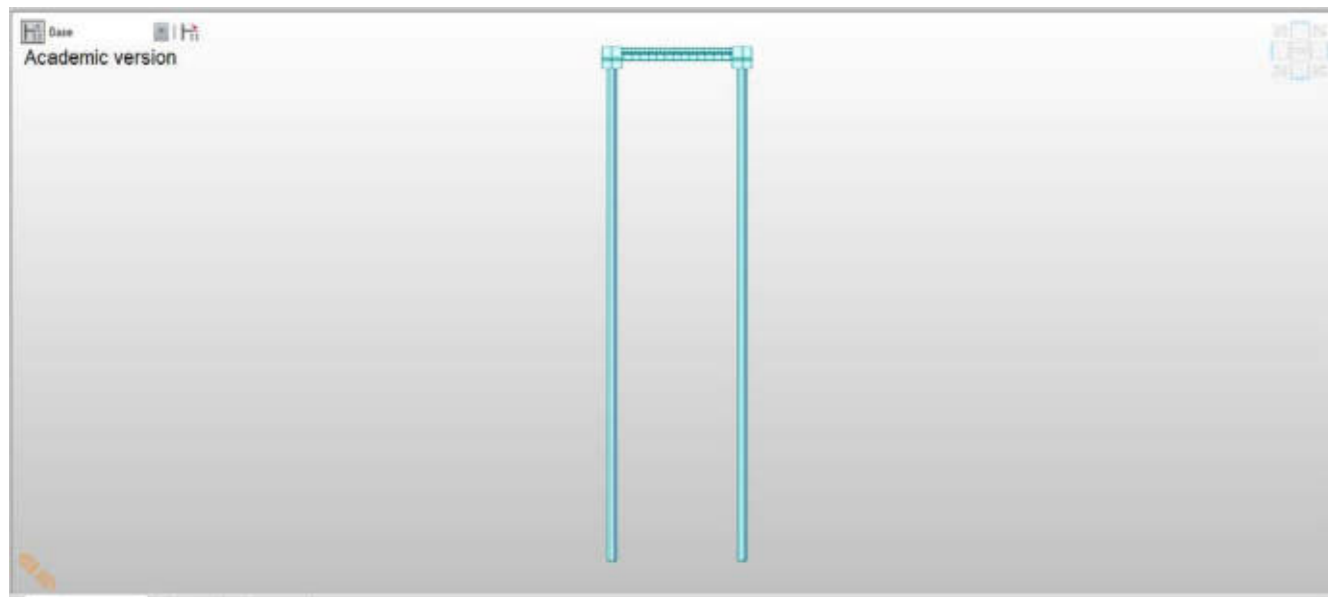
Generación del resto de pilares en los puntos definidos en los planos constructivos
